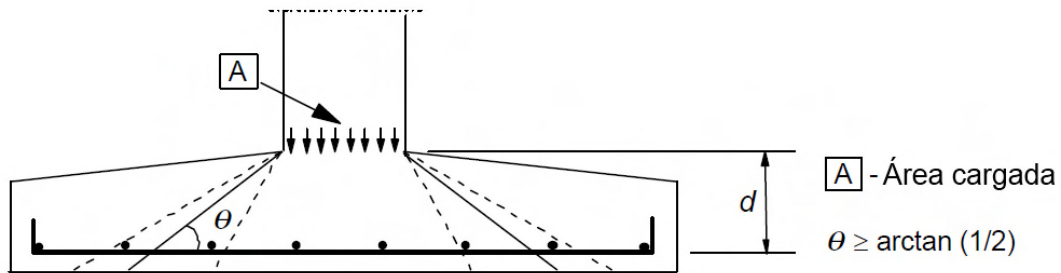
canto de la sección crítica para una zapata de canto variable
